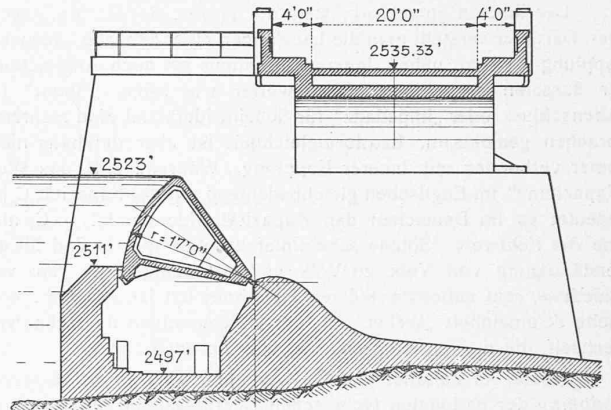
Schnitt 1 : 250 durch das Wehr mit dem bewegl. Eisenbetonstaukörper.
